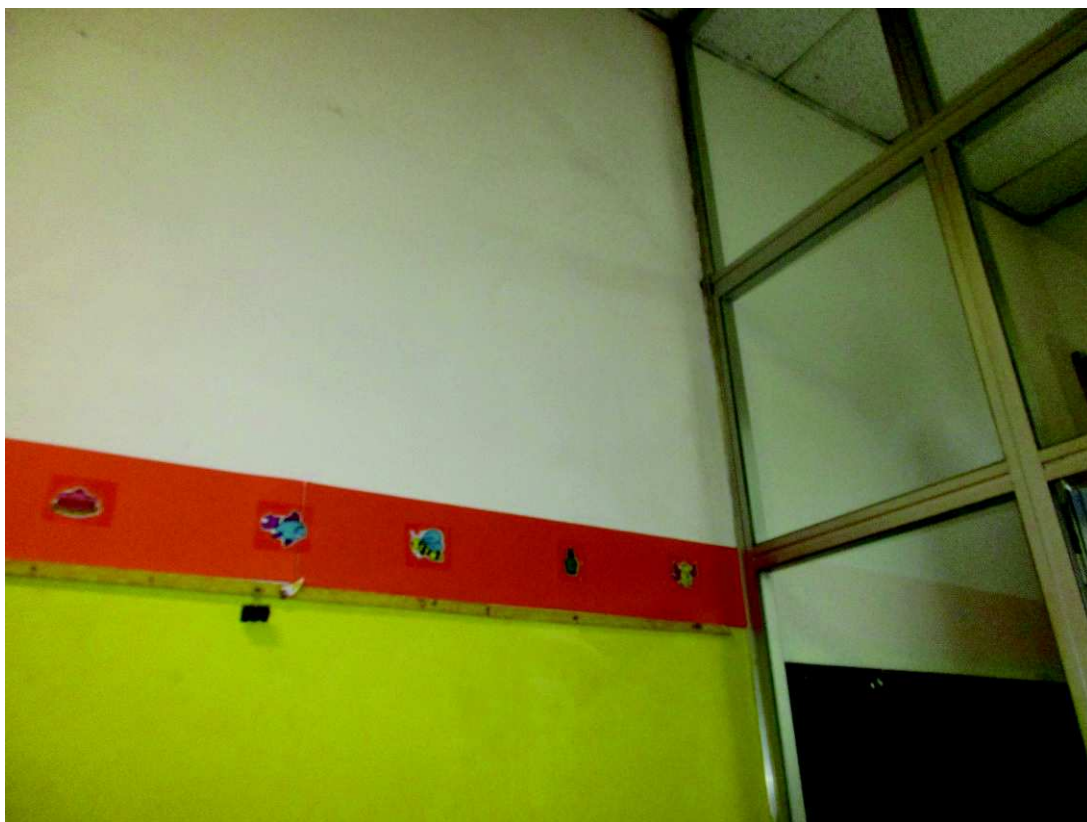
all'ingresso piccola fessura verticale sulla parete portante interna lato est
